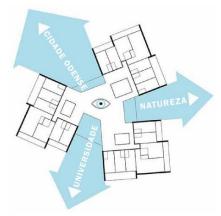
Planta esquemática demonstração do campo de visão do projeto
